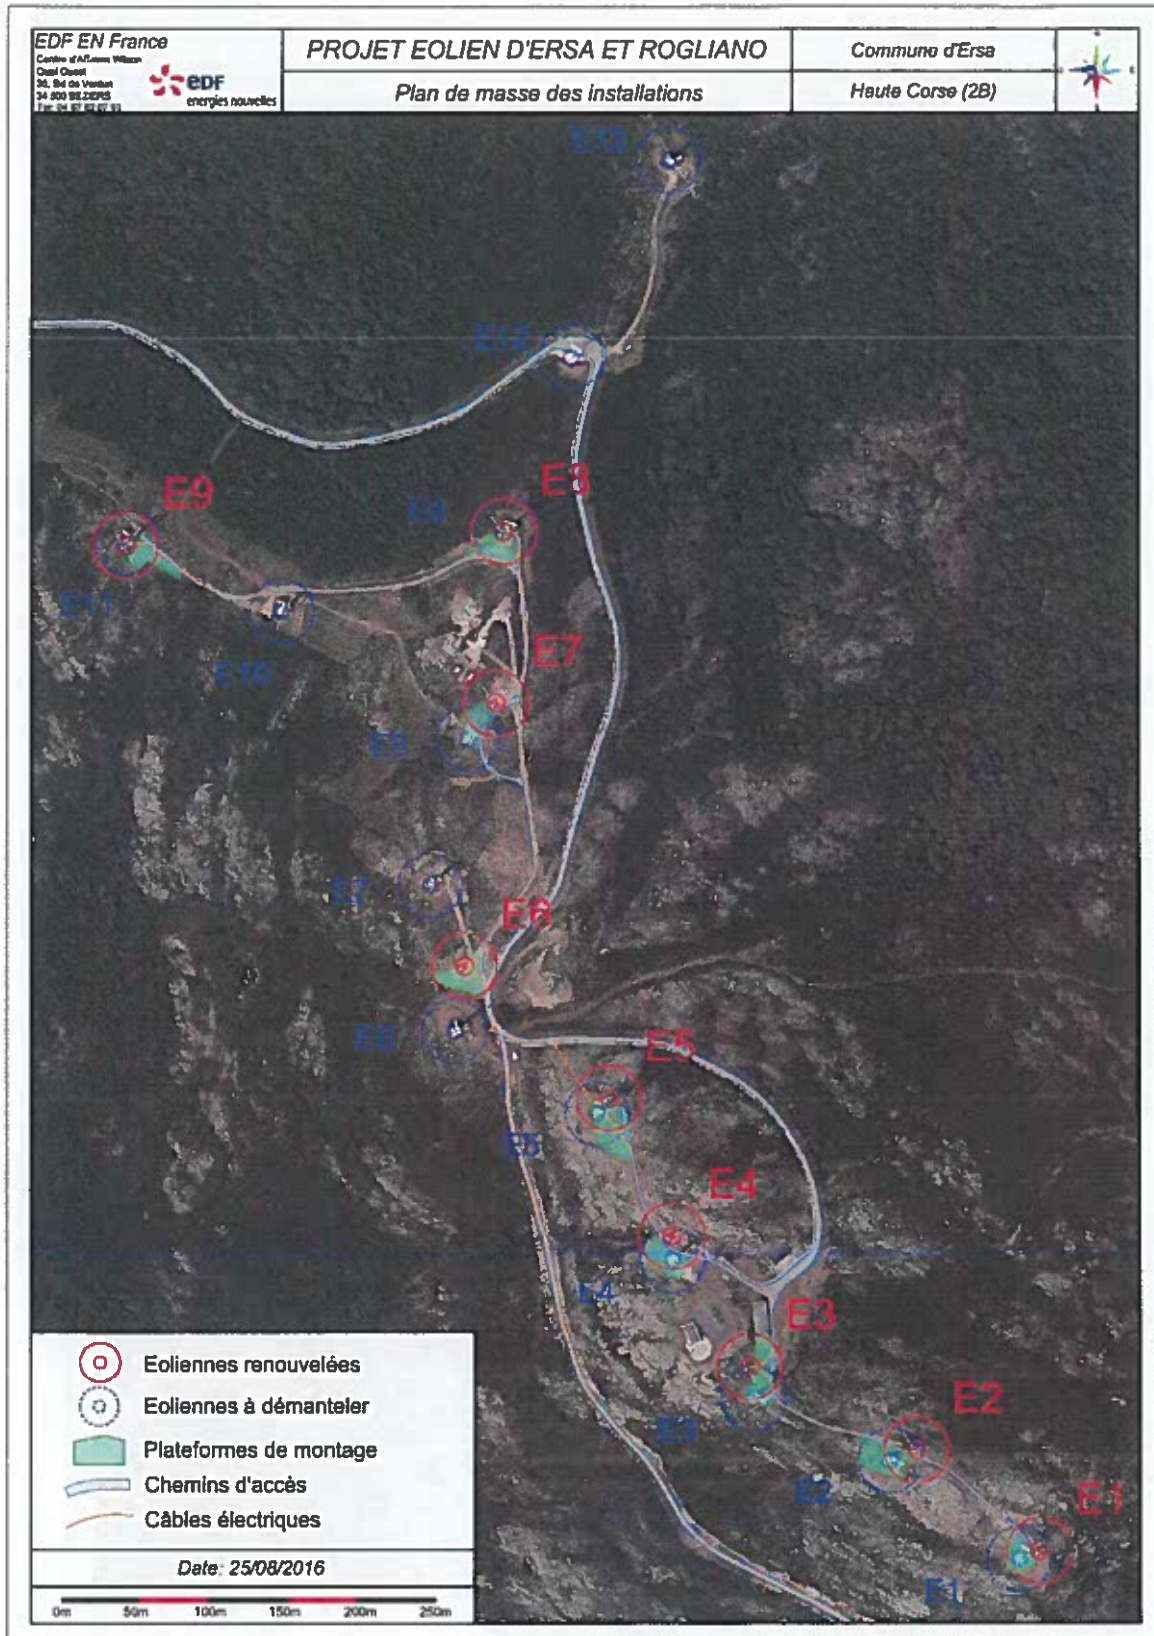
Plan masse des installations, commune d'Ersa, EDF EN 2016
